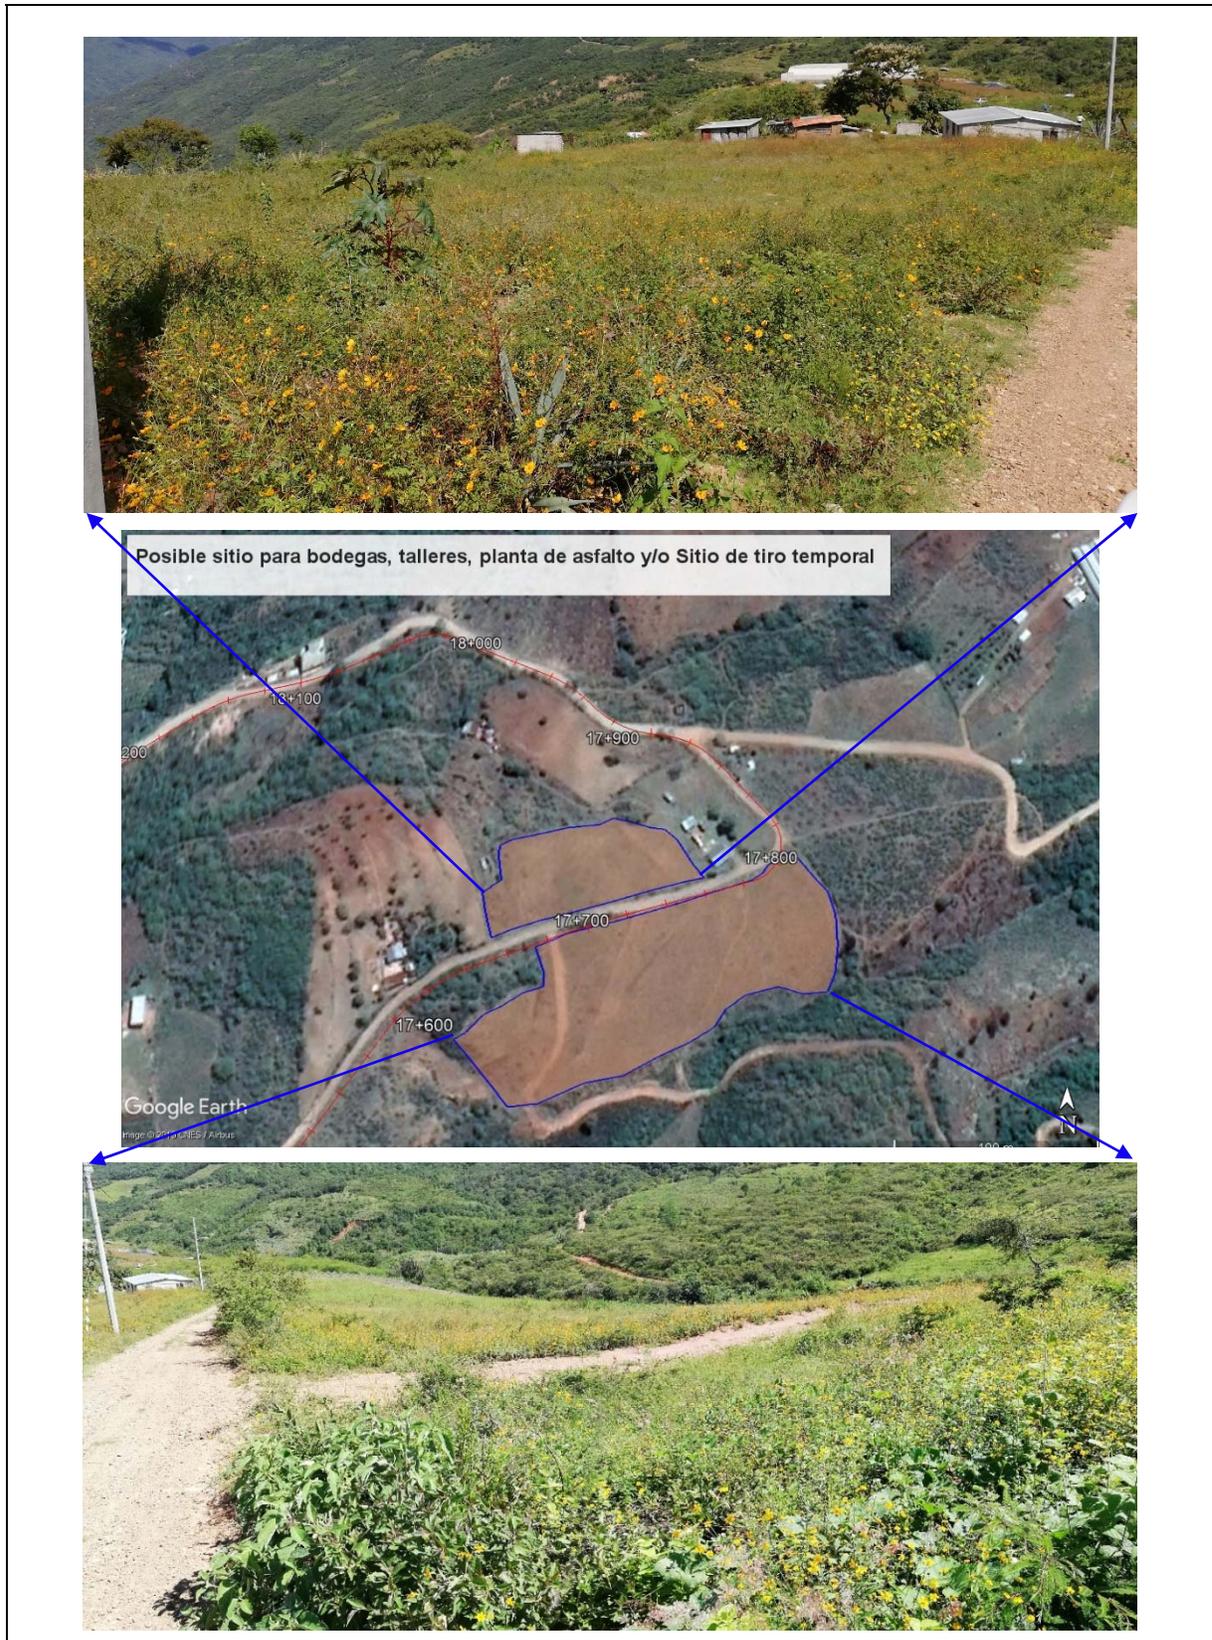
Posible sitio para bodegas, talleres, planta de asfalto y/o Sitio de tiro temporal, km 17+700 ambos lados.
